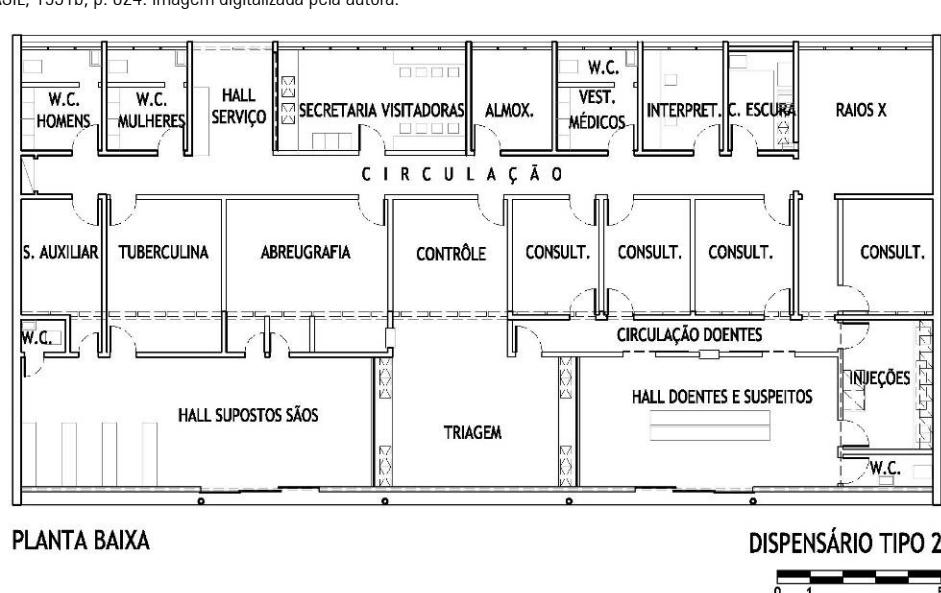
Planta Baixa do Dispensário Tipo IIB do SNT, divulgada em 1958.
